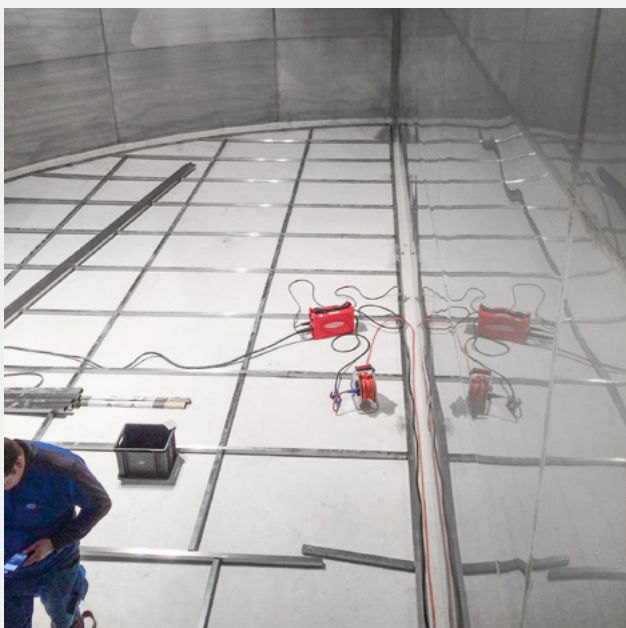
Reservoir Wahlen: Erstellung der Boden-Unterkonstruktion aus Edelstahlprofilen. Die Zwischenräume wurden anschliessend mit Rundsplitt verfüllt (Lastabtrag) und die Edelstahlbleche auf der Unterkonstruktion verschweisst.
